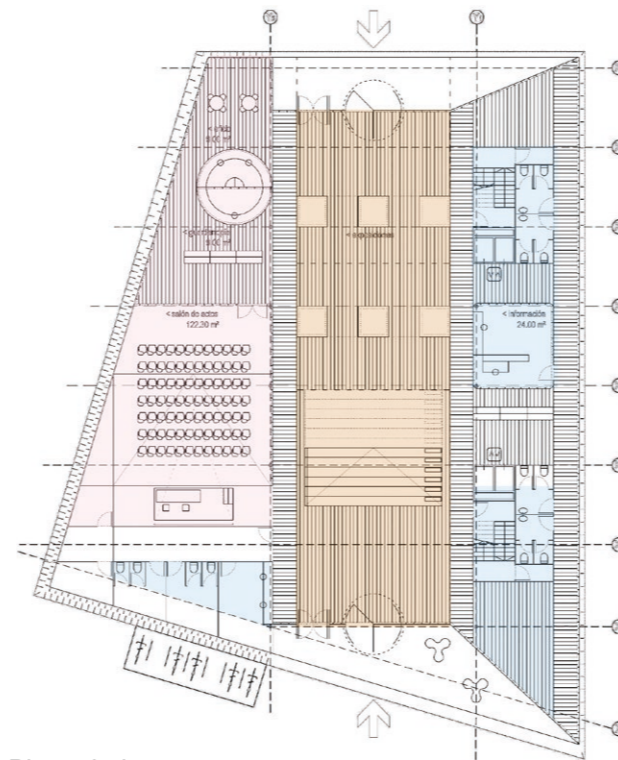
Planta baja. Adaptado de Plataforma de Arquitectura, 2016
